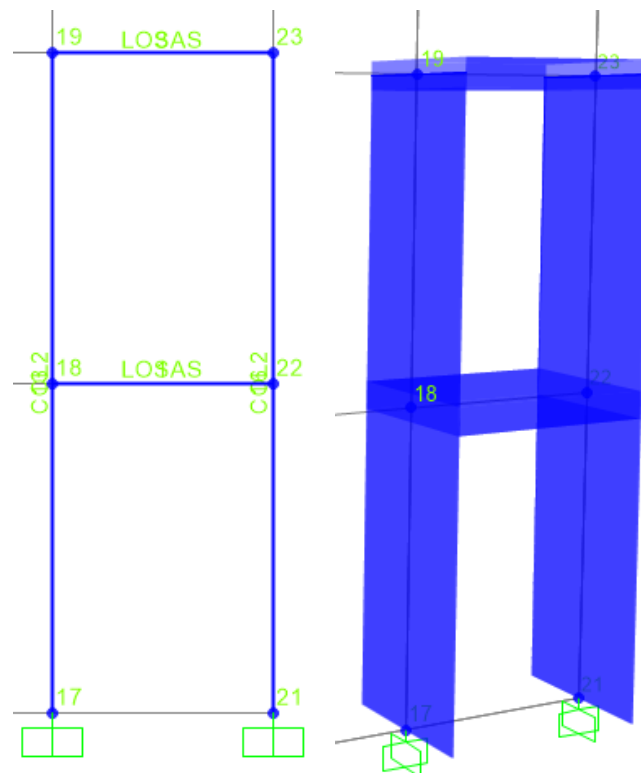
Vista Frontal y vista extruida del modelo estructural.
